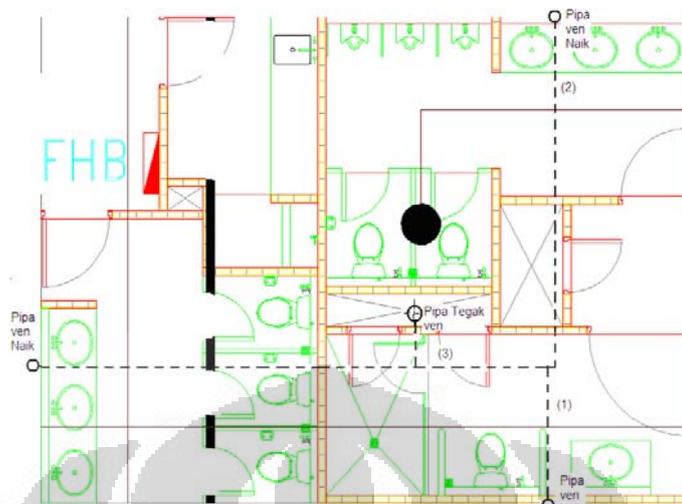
Denah Pipa Ven pada Lantai Dasar
